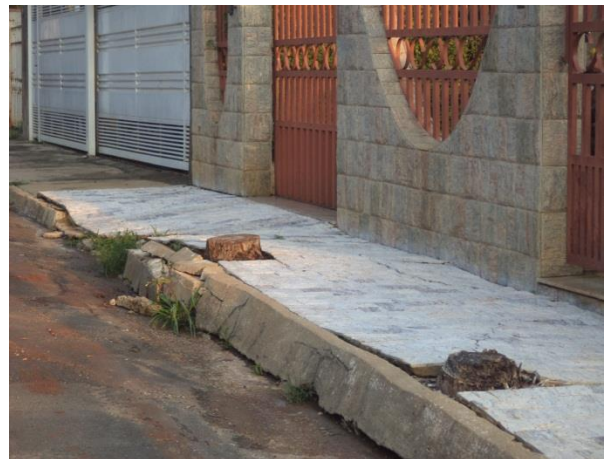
Imagens dos danos de chuva - Bairro Vista Alegre
